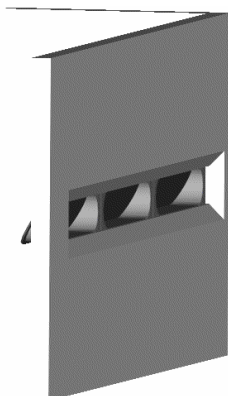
Clapetas antimarea instaladas en el muro de alivio. Vista trasera.
